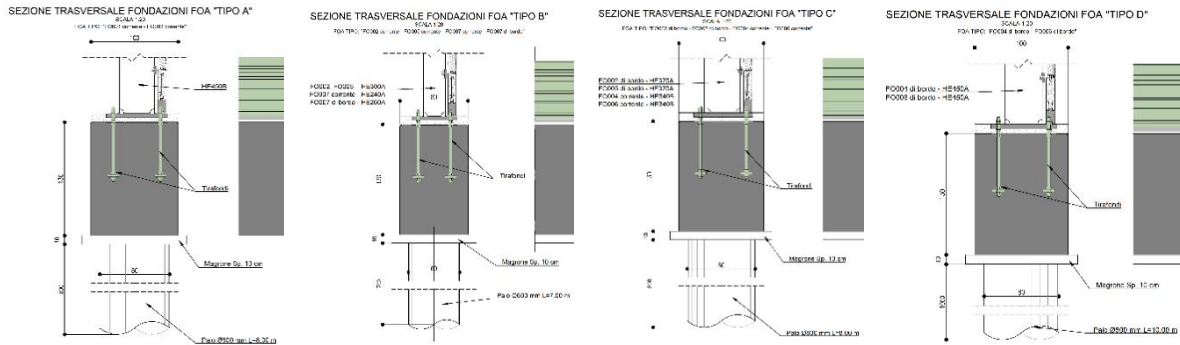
Sezioni tipo cordoli di fondazione FOA
